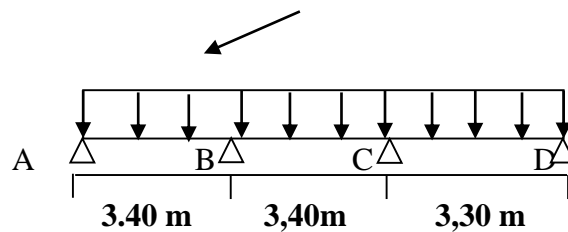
Schéma statique de la poutrelle à l'ELS.
